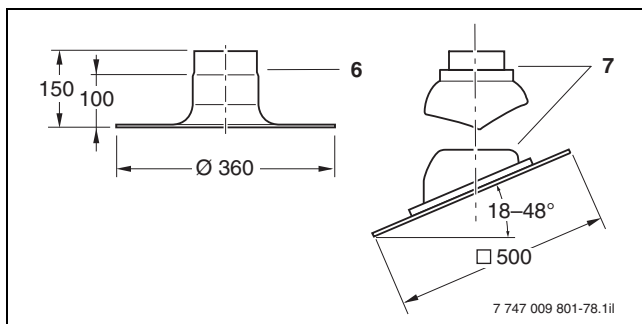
Universal-Dachziegel und Flachdach-Klebeflansch als Zusatzausstattung für den Grundbausatz DO (Maße in mm)
